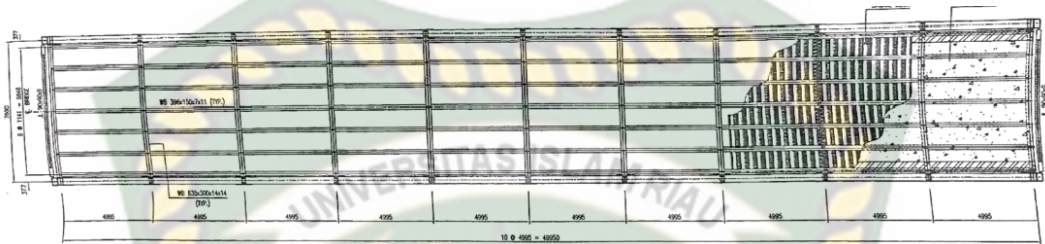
Denah Bawah Jembatan Bentang 60 m
